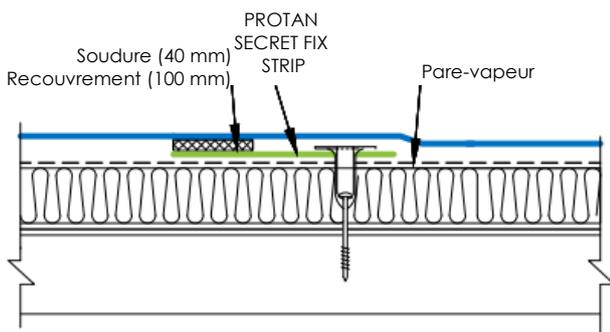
Recouvrement des lés (PROTAN SECRET FIX STRIP)
